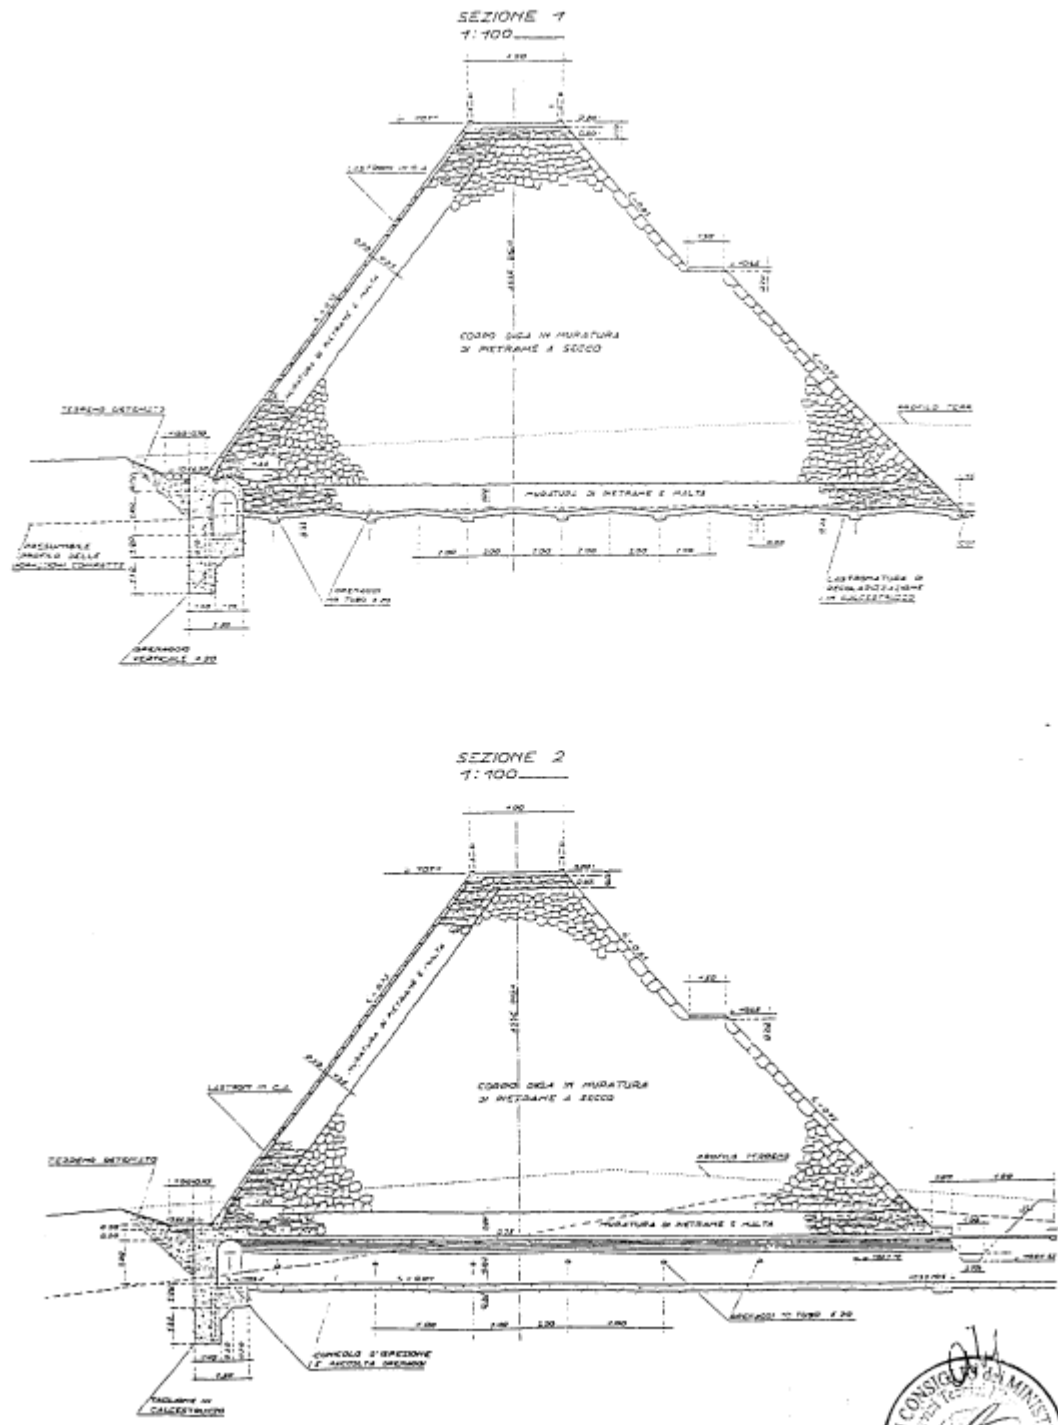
Invaso di Montagna Spaccata. Diga 3 in muratura di pietrame a secco. Sezioni Tipo
